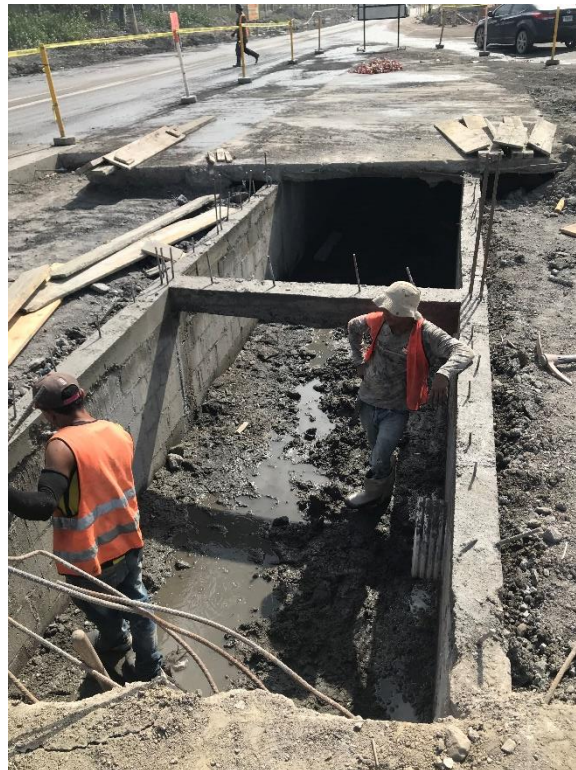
Picado de paredes en canal colector de drenaje pluvial
